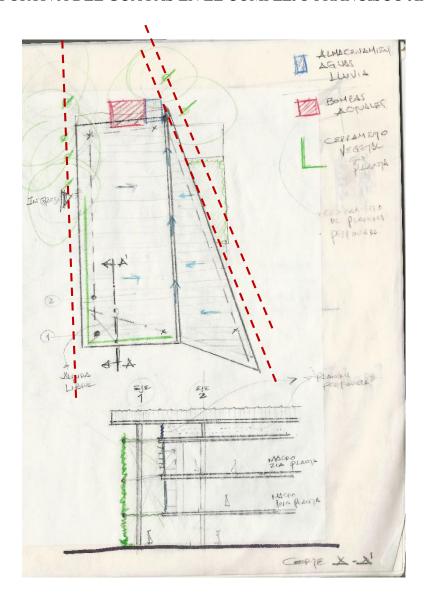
Partido Arquitectónico. Plano y corte esquemático de Macrogym con fachada vegetal implementada.
